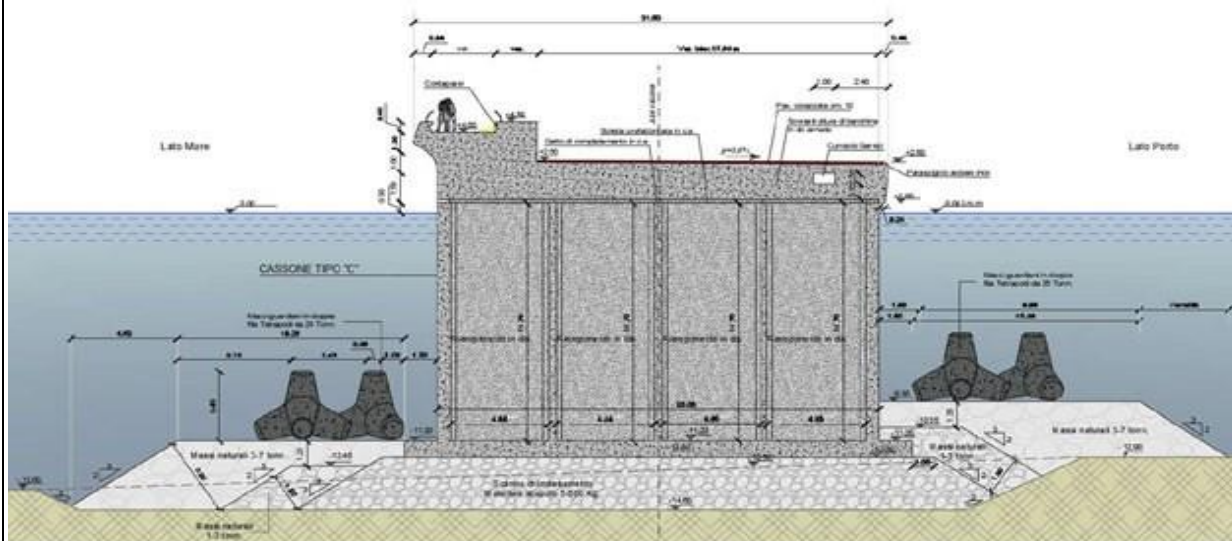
Sezione tipo A-A (Cassone tipo C)
